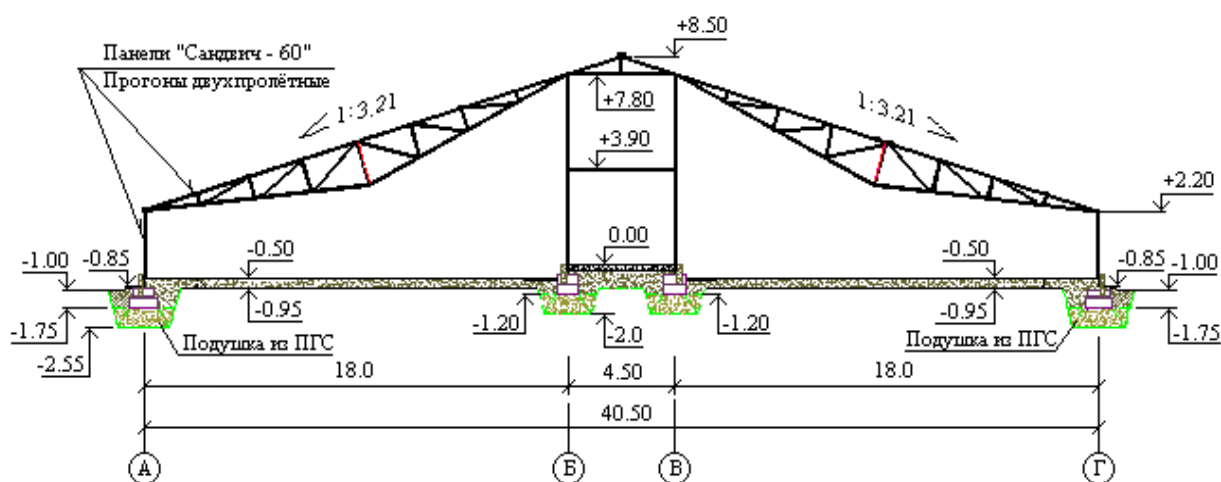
Поперечник здания с фундаментами мелкого заложения
